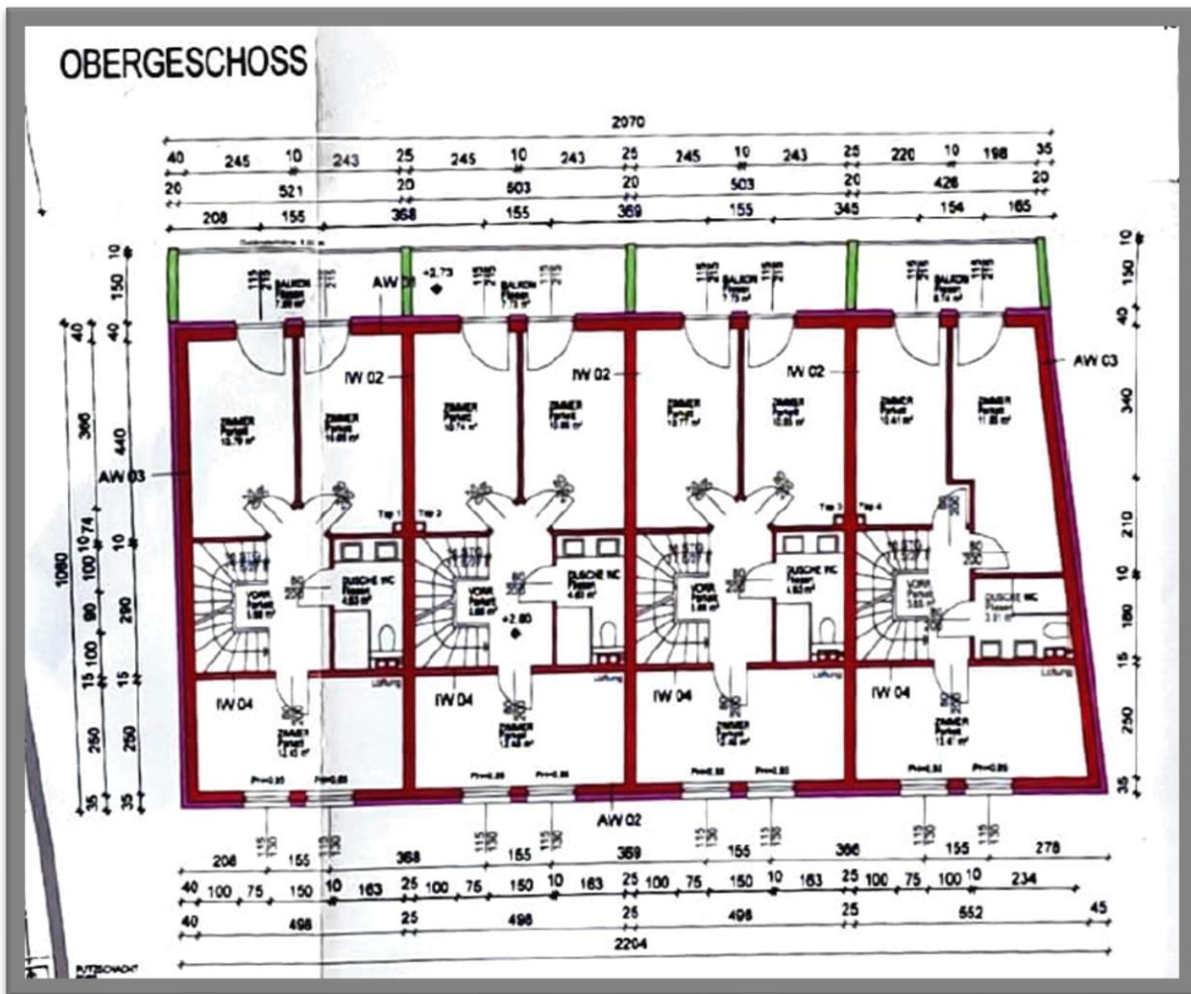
Grundriss OG - Haus 1-4
